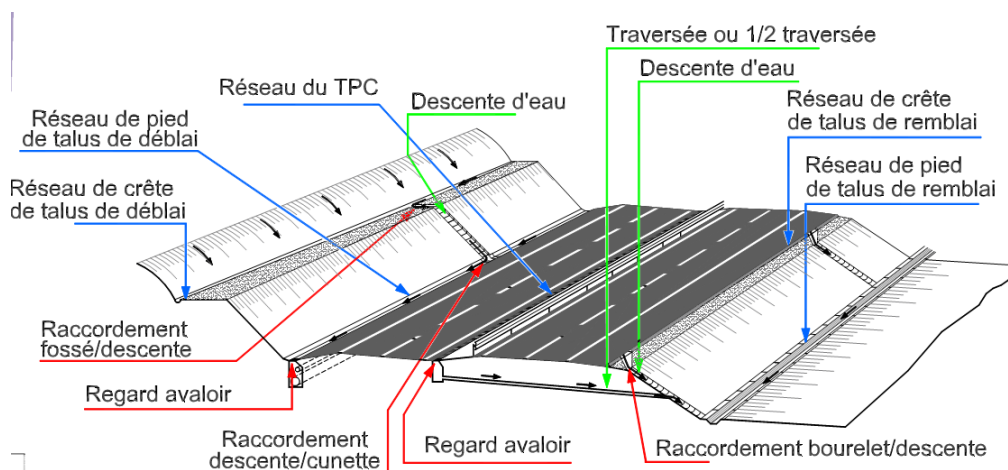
Situation des réseaux sur le profil en travers d'un Autoroute.
